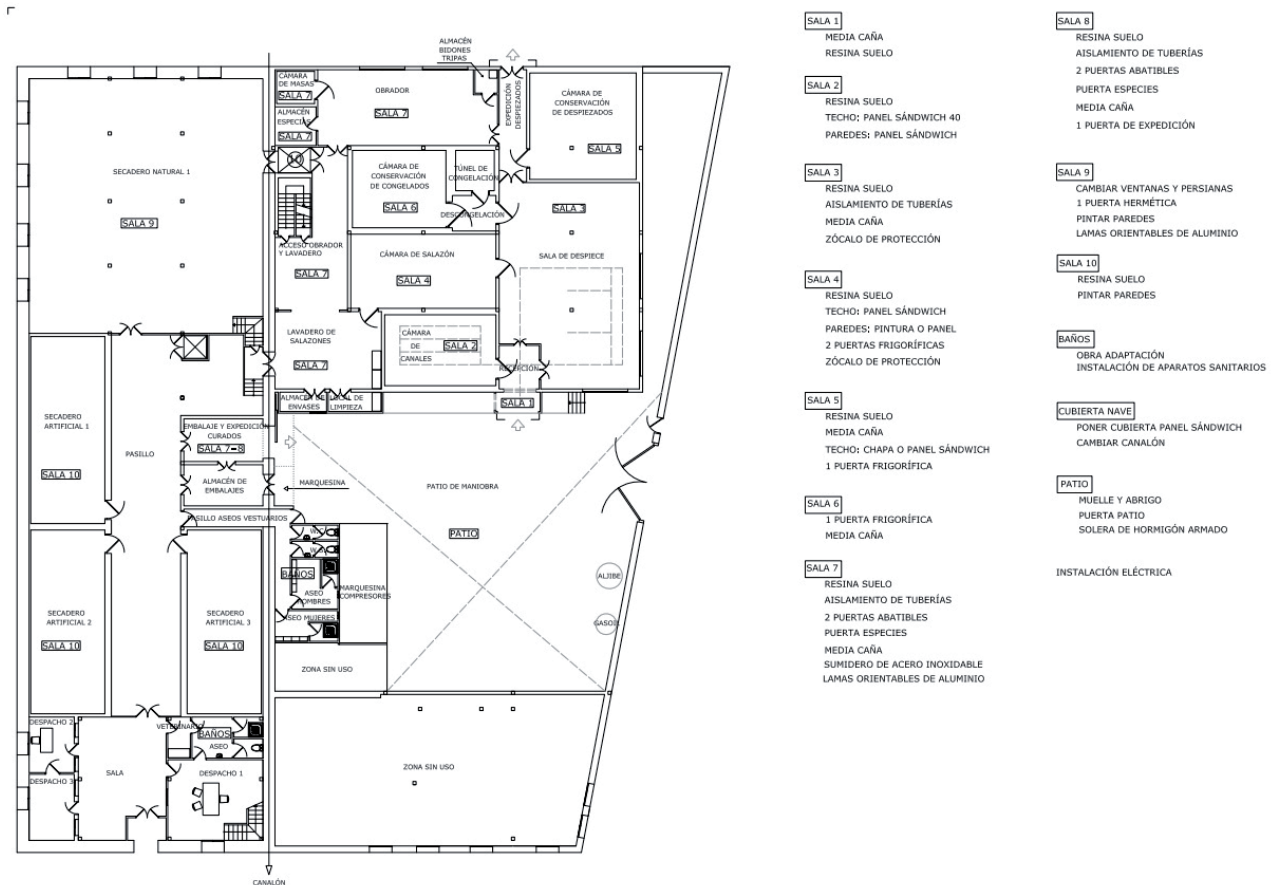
Situación proyectada de las instalaciones de la planta baja
